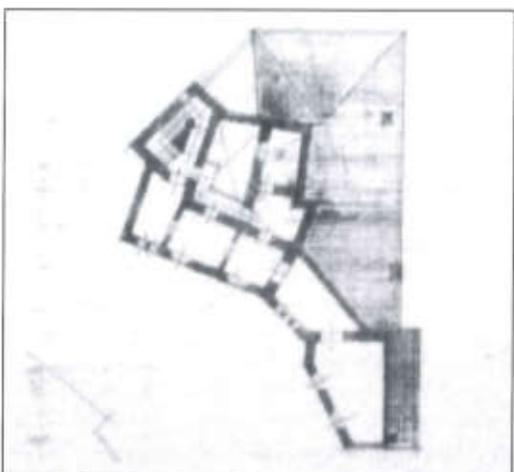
/Studio progettuale planimetrico del piano secondo di P. Fidenzoni.
